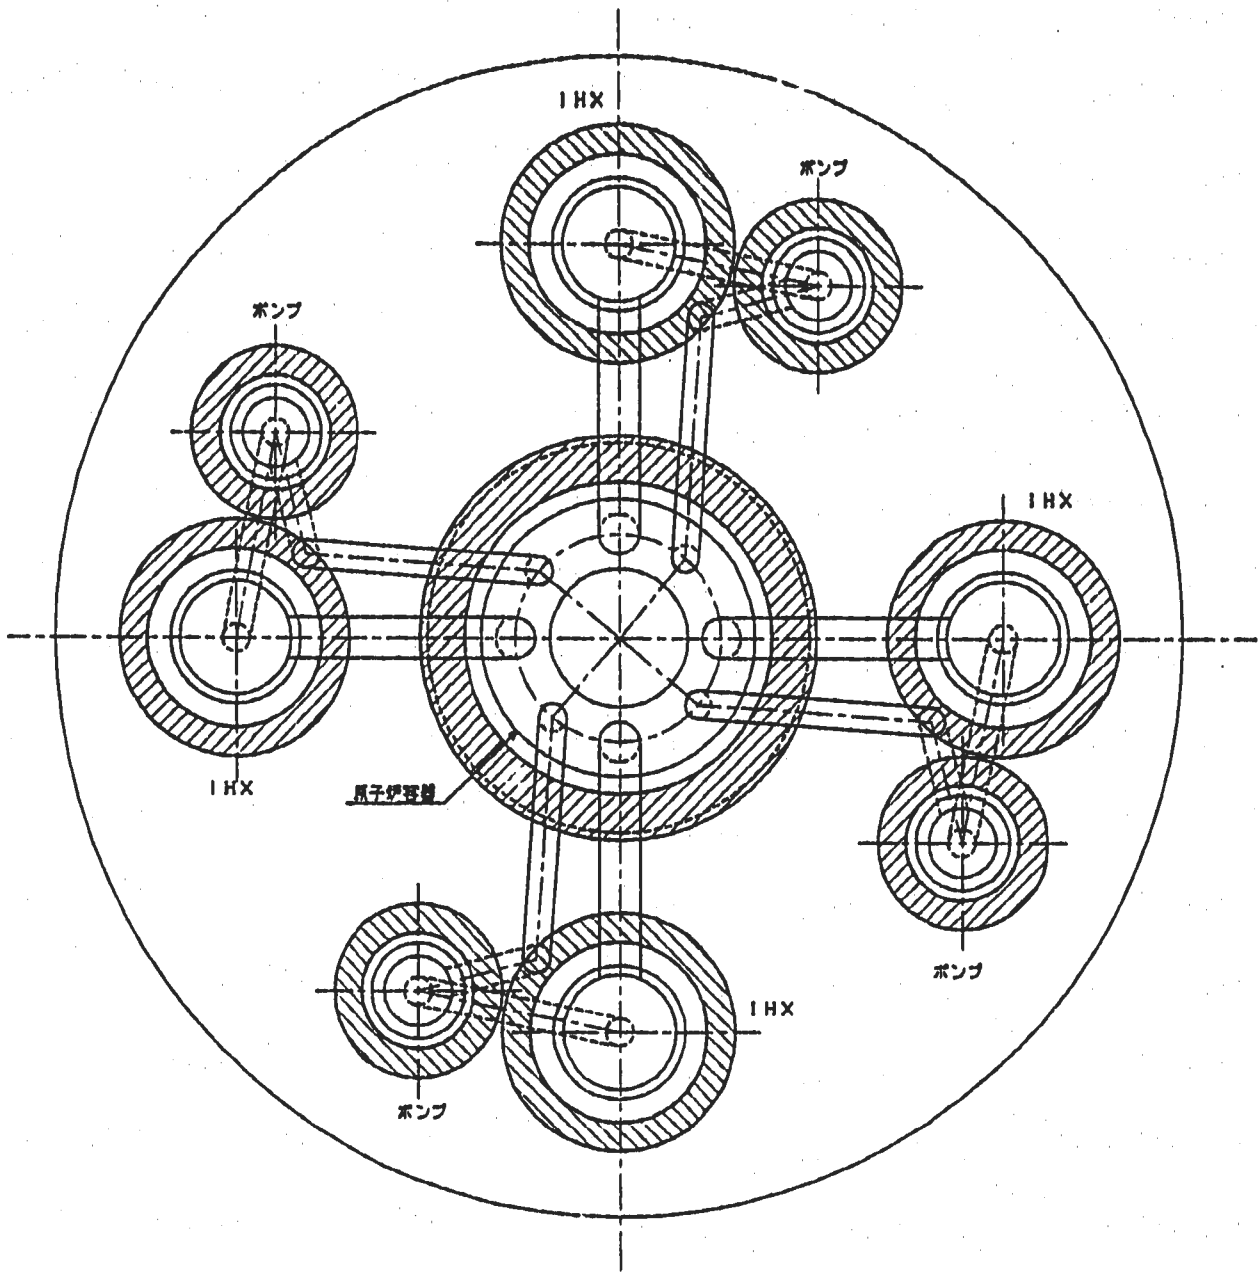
皿ばね平面配置図 (リファレンスケース)
